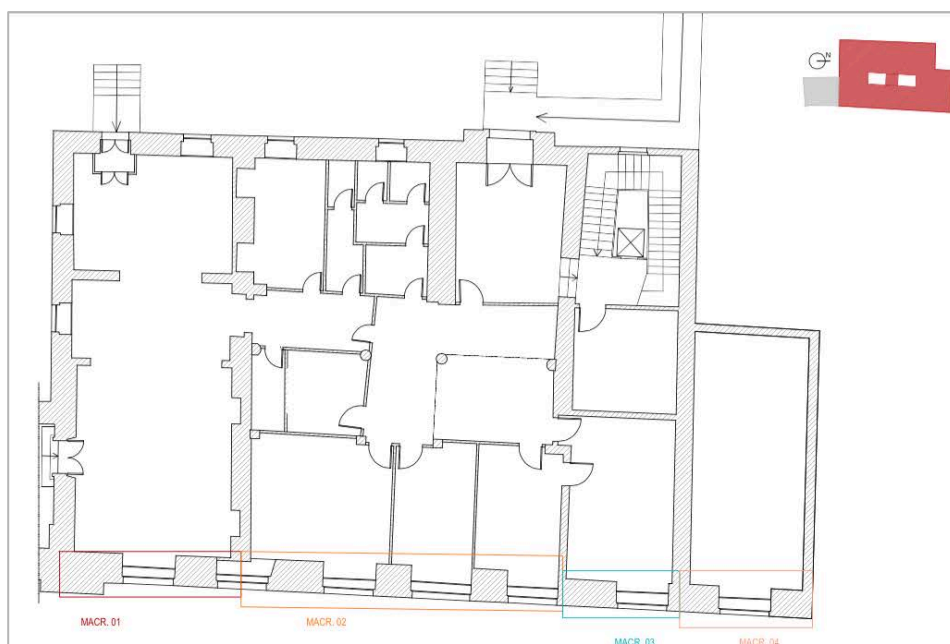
Individuazione in pianta dei macroelementi _ prospetto est
